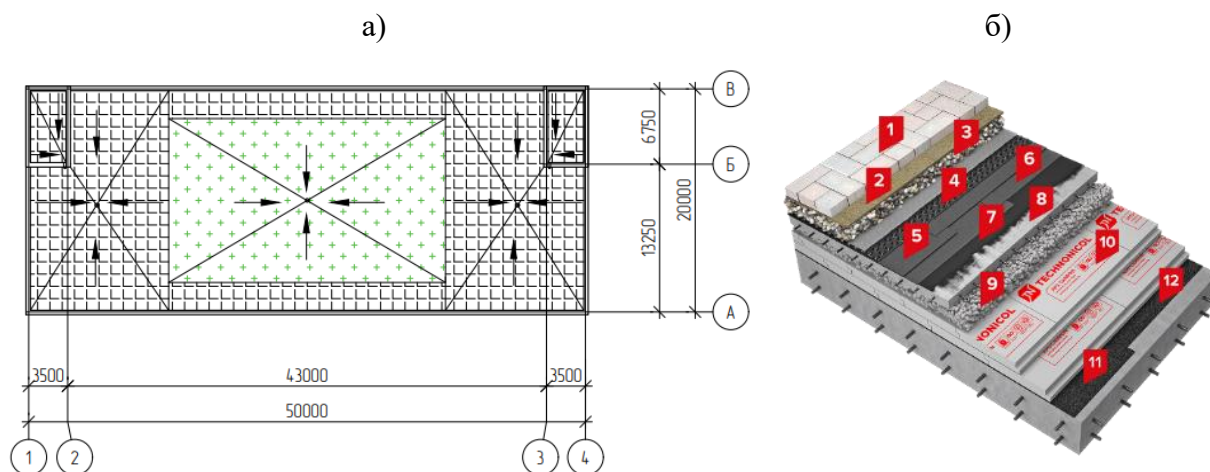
Эксплуатируемая крыша с экстенсивными насаждениями: а) план крыши; б) состав кровельного пирога: 1 – бетонная плитка; 2 – цементно-песчаная смесь; 3 – гравий фракцией 5...10 мм; 4 – профилированная мембрана; 5..6 – гидроизоляция битумно-полимерная; 7 – битумный праймер; 8 – армированная цементно-песчаная стяжка; 9 – уклонообразующий слой – керамзитобетон; 10 – теплоизолирующий слой – экструзионный пенополистирол; 11 – пароизоляция; 12 – железобетонная плита
